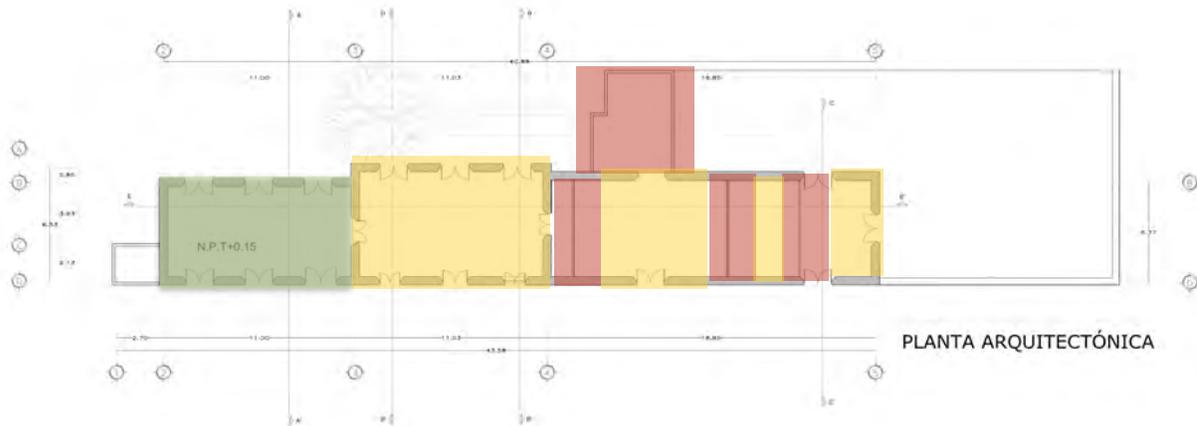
Planta Arquitectónica, Elaboración Propia, PGPL, 2016.
